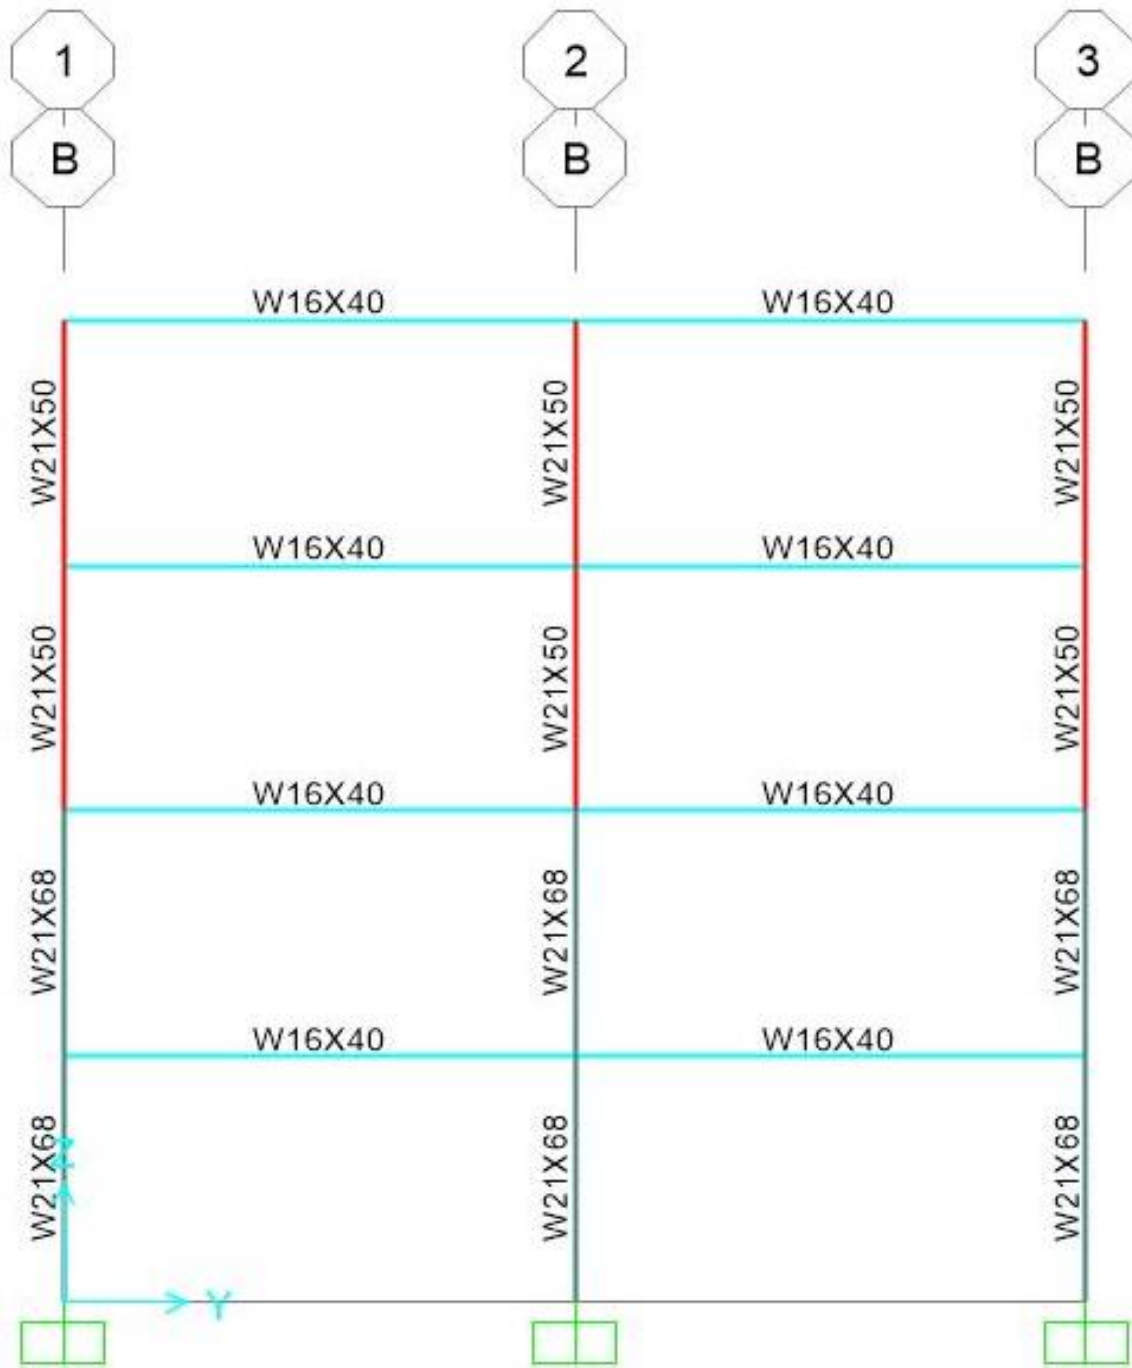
8 Elevación estructural EJE-B (Fuente propia).
